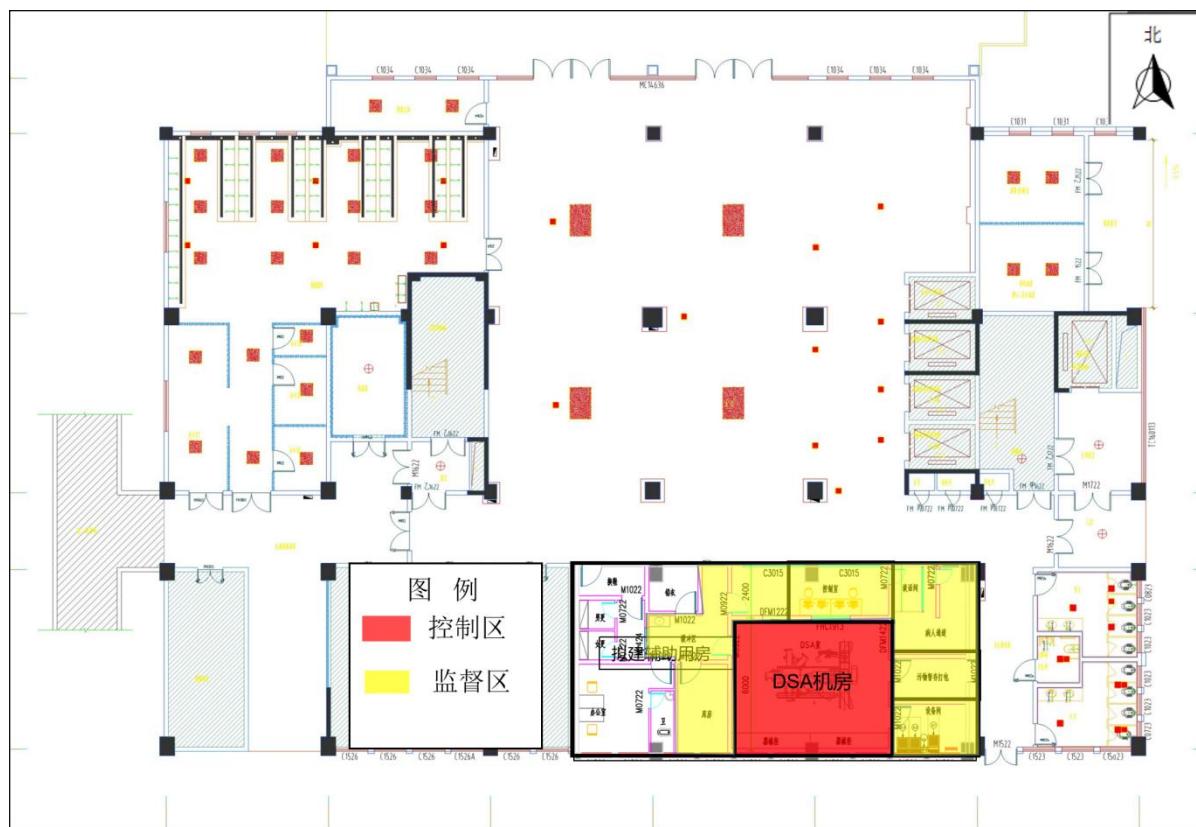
本项目辐射防护分区示意图（一楼平面图）
